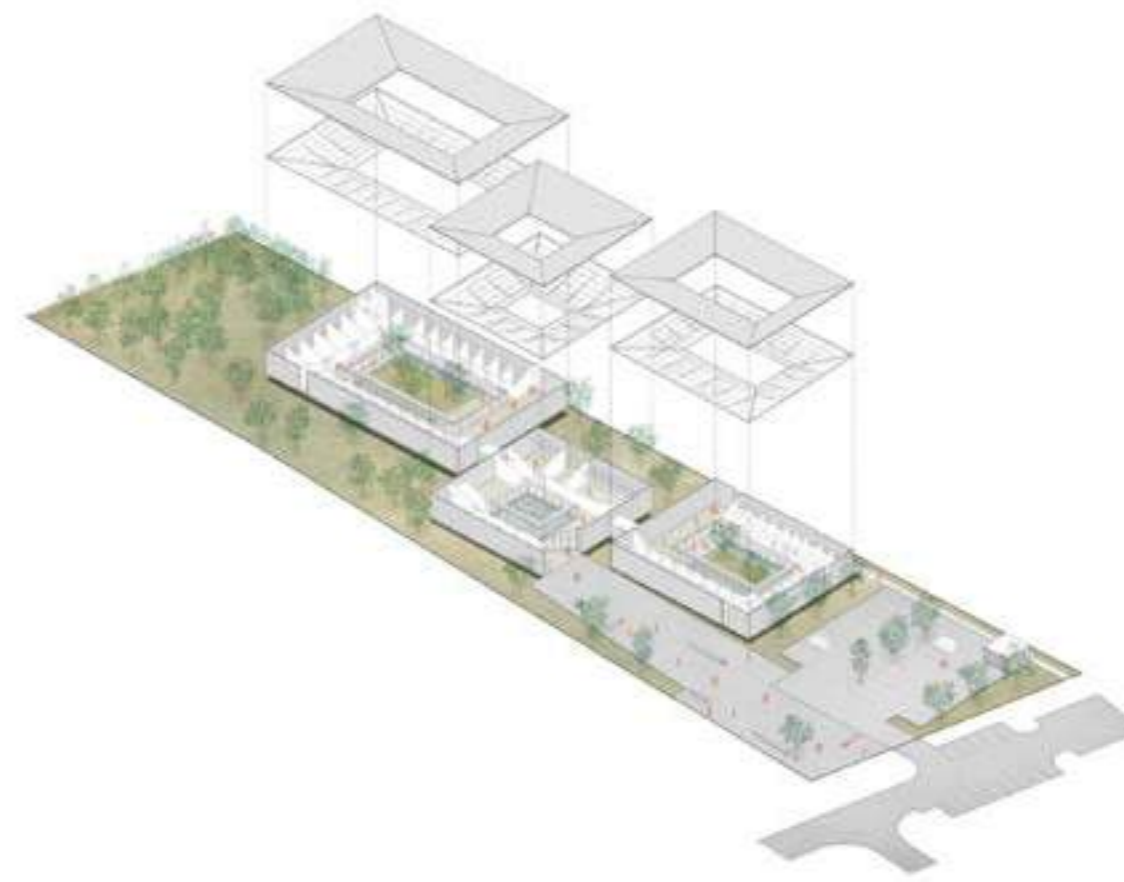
Axonometría de la edificación Fuente: Saboia+Ruiz Arquitectos
